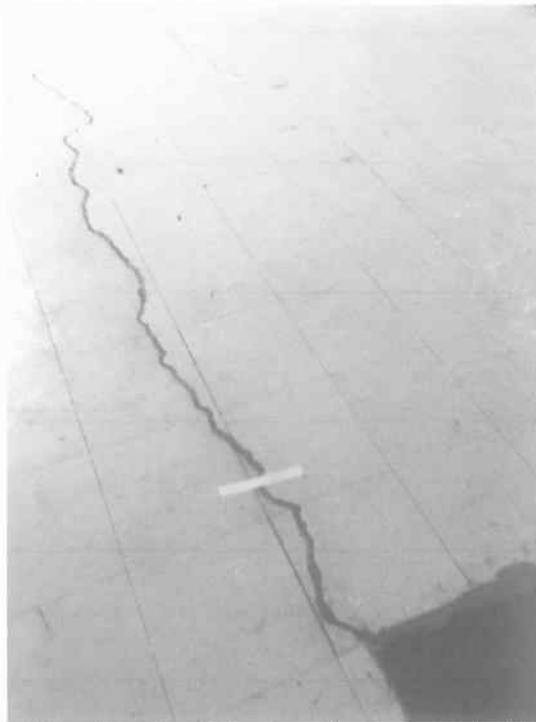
, grieta en la losa tapa del cajón de cimentación
